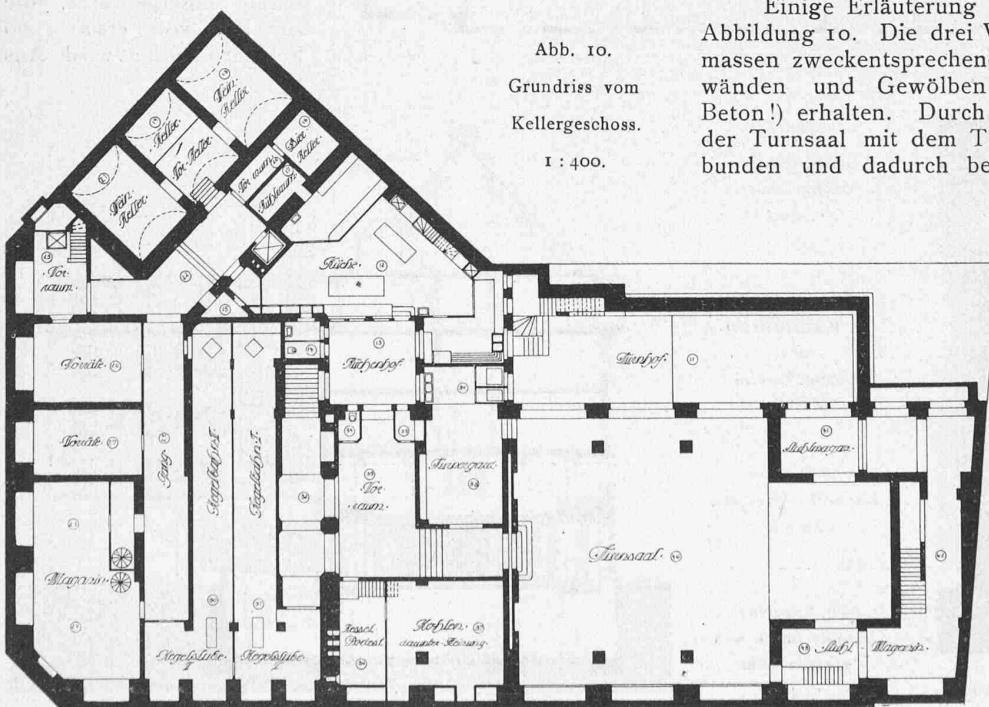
Grundriss vom Kellergeschoss. 1 : 400.
